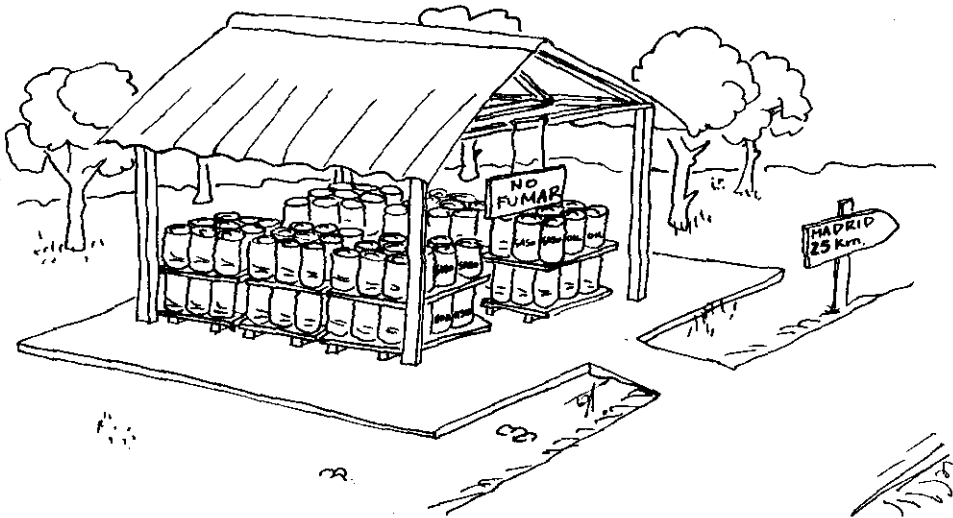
ESQUEMA BASICO DE UNA ZONA DE ALMACEN DE COMBUSTIBLES.
